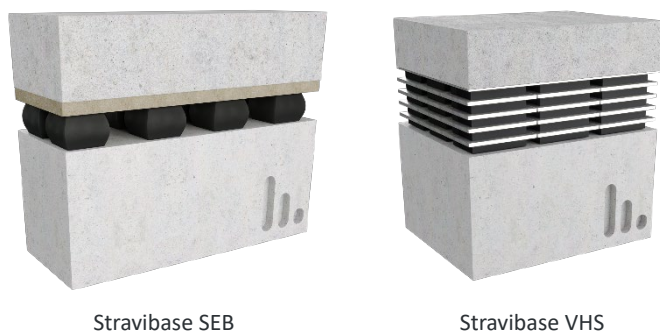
CDM Stravitec Building Base Isolation oplossingen
